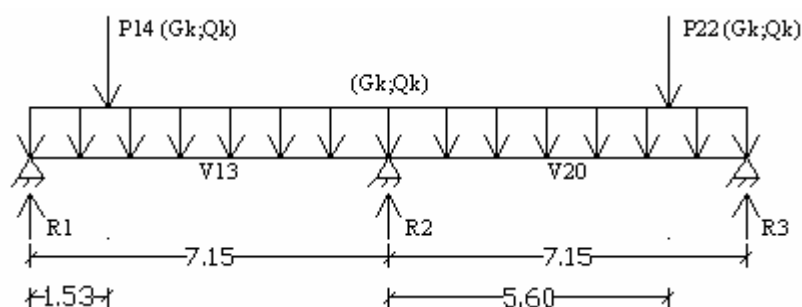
Modelo estrutural adoptado para as vigas V13 e V20
